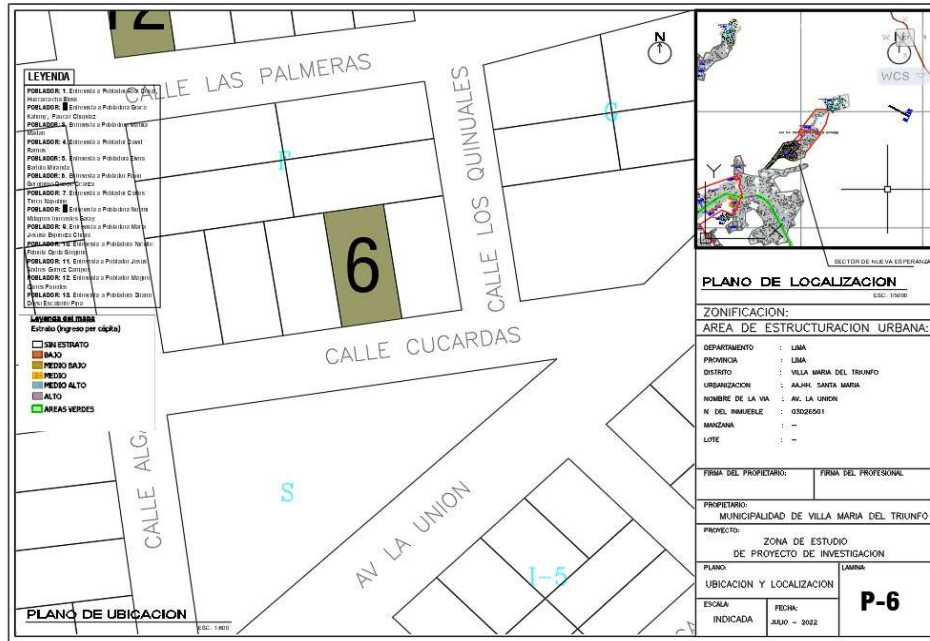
Plano de Ubicación de Casa de la Señora Elvira Bartolo Miranda
